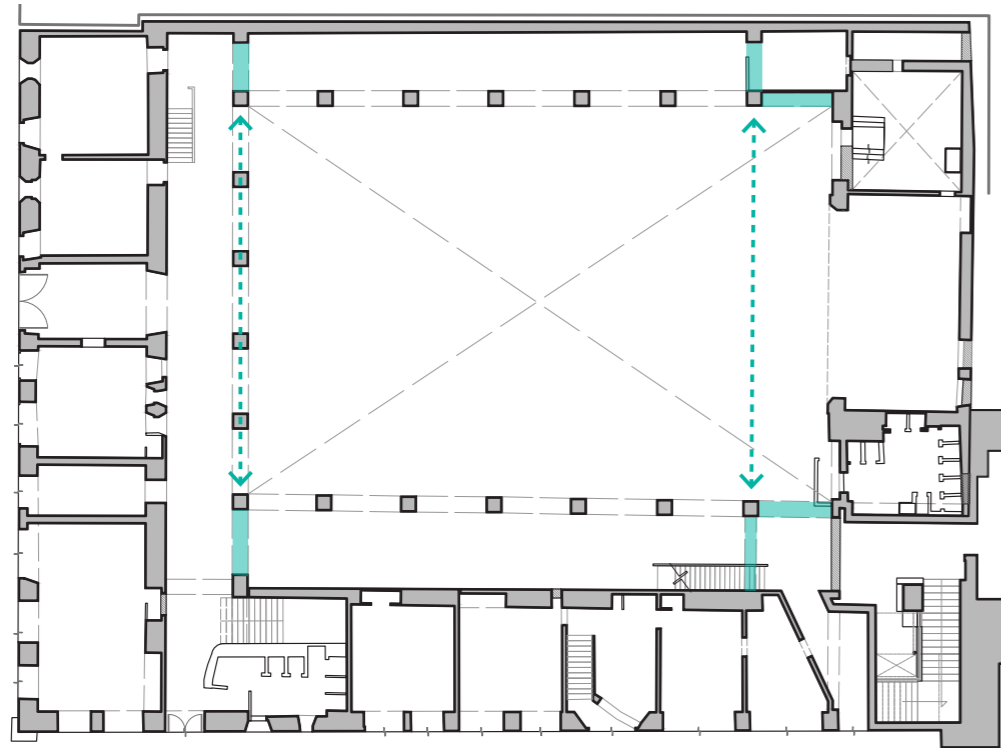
Vista en planta de la continuación de los arcos en pasillos hasta las esquinas de las crujías.
